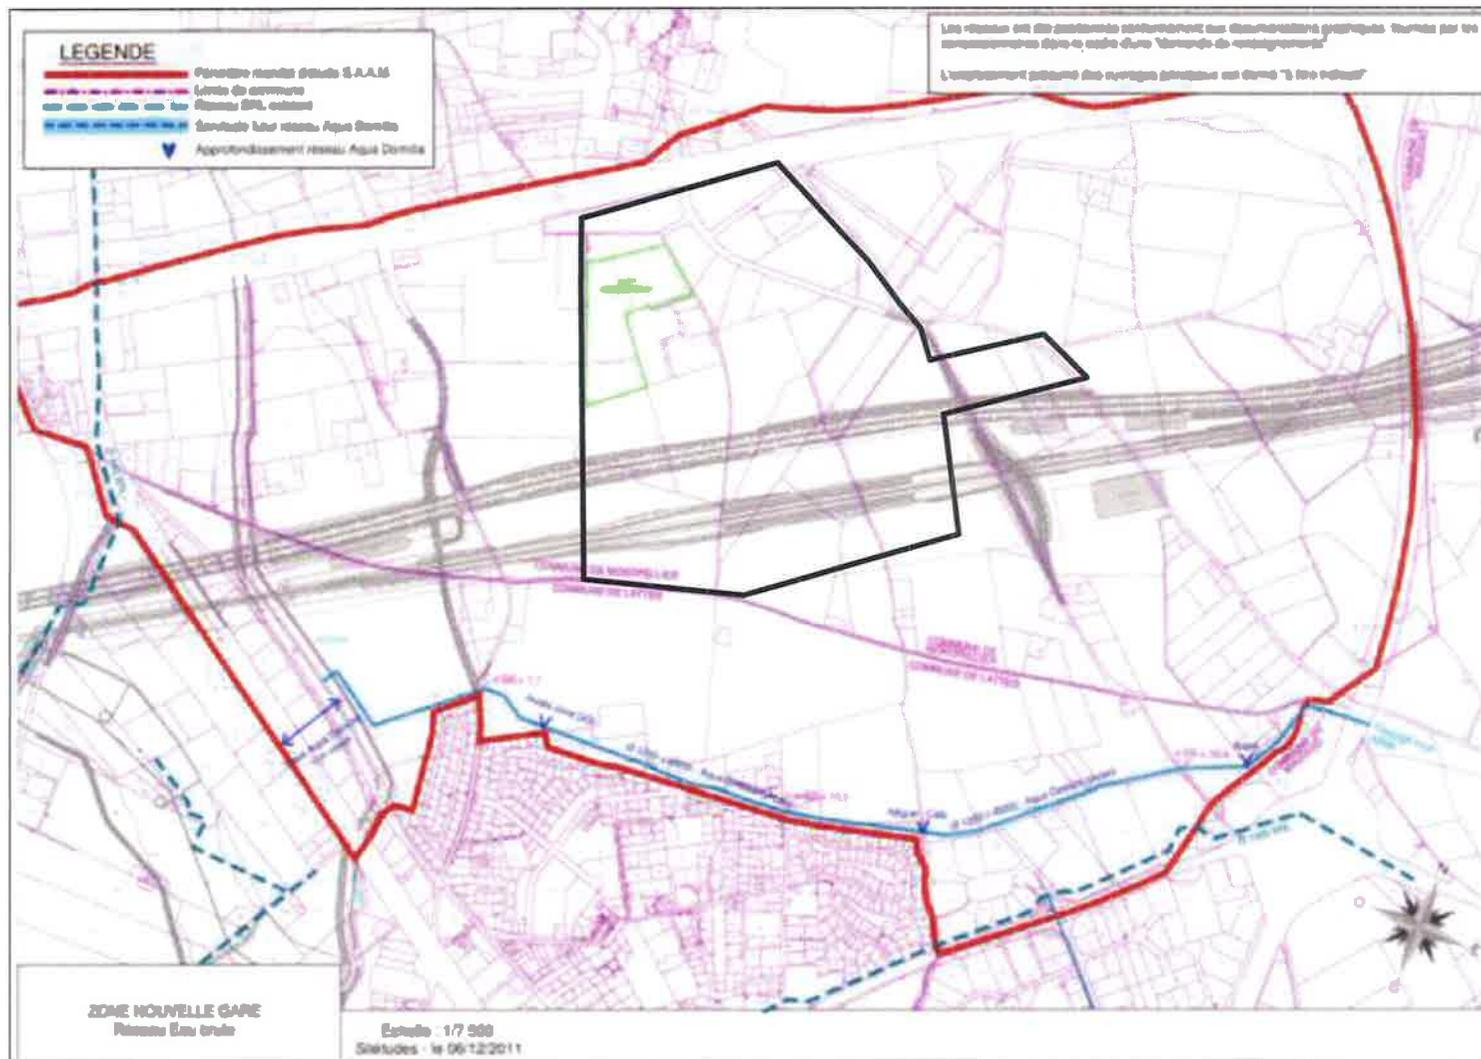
Plan des réseaux d'irrigation sur la zone d'étude
